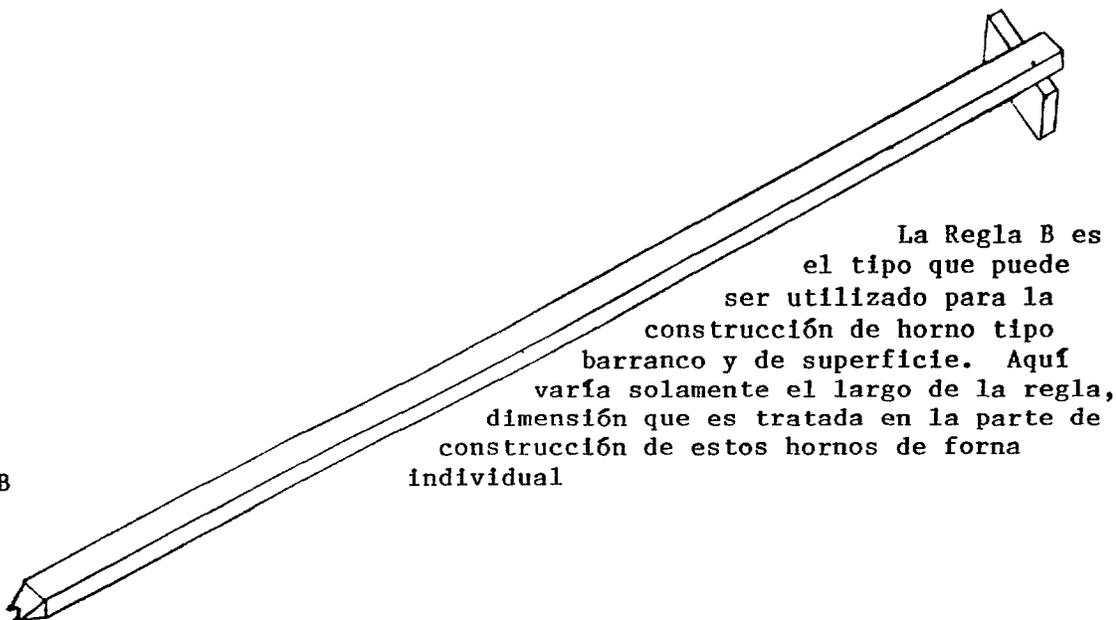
Tipos de reglas a utilizar en la construcción de hornos de ladrillos.
